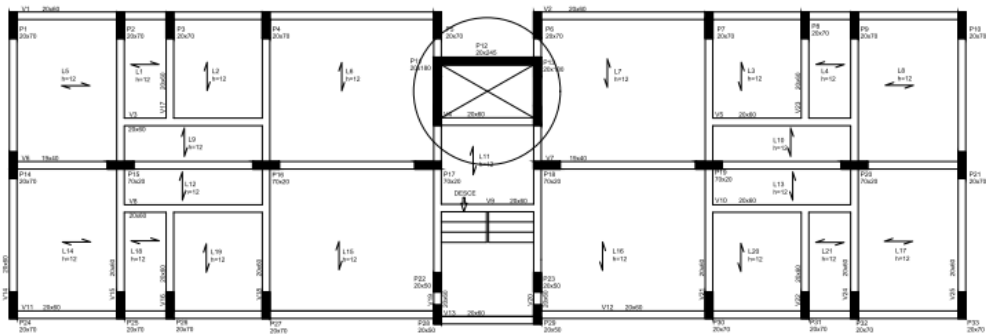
Planta tipo Caso 4 – núcleo rígido na região do elevador
